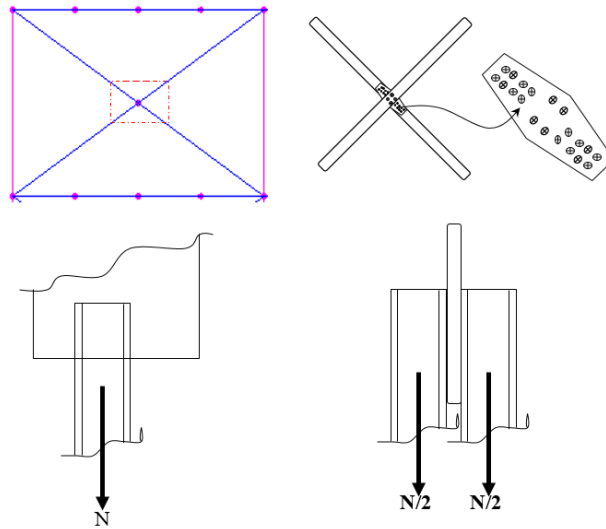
4 Attache de 2UPN sur un gousset au niveau d'intersection :
